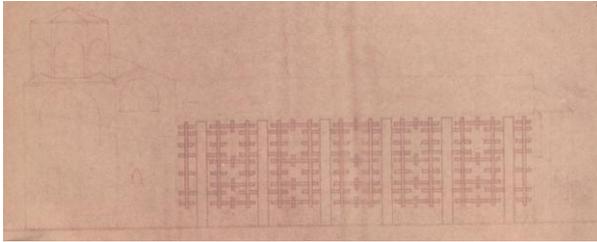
Proyecto de enderezamiento de las fachadas sur y oeste de Marijan Mushić.
